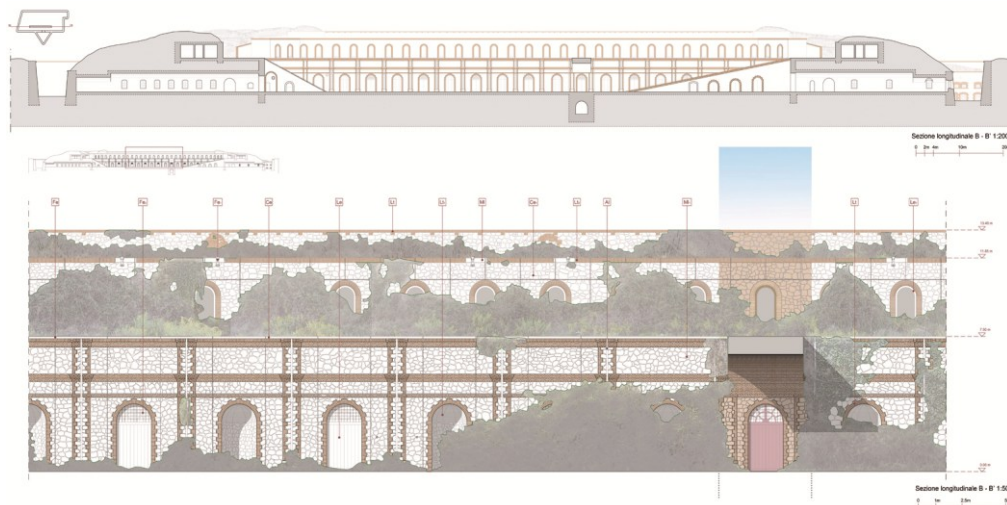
Sezione / prospetto della trincea di Forte Siacci.
